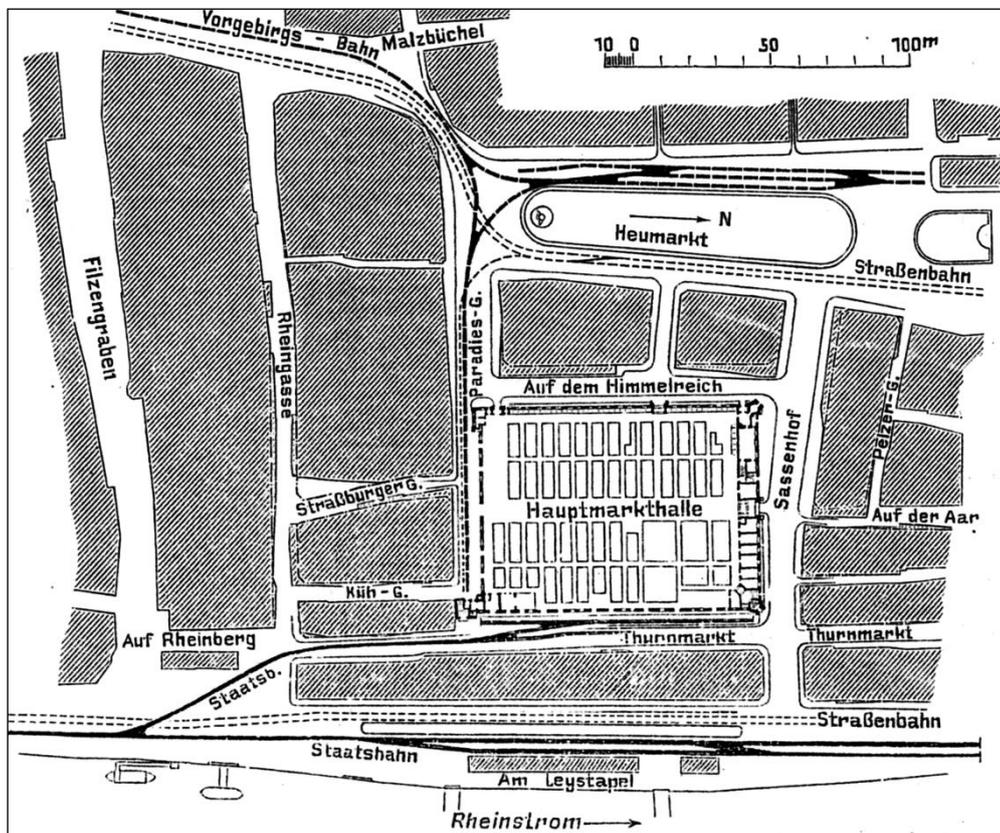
Lageplan der im Jahre 1904 eröffneten Kölner Hauptmarkthalle am Sassenhof. Unten der Leystapel, oben der Heumarkt.
